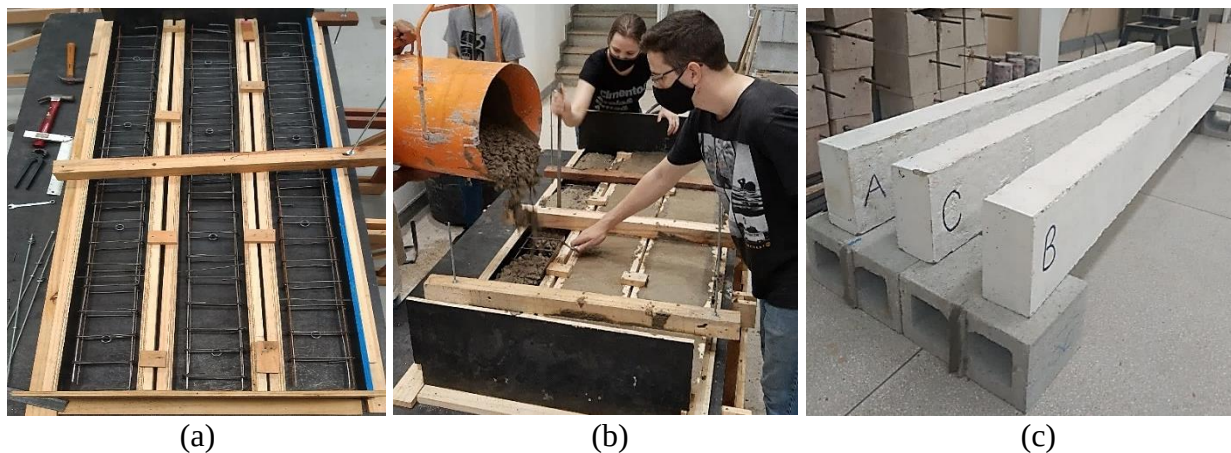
Produção das vigas de concreto armado. (a) Posicionamento da armadura nas formas; (b) concretagem; (c) vigas após a cura e a desforma.
